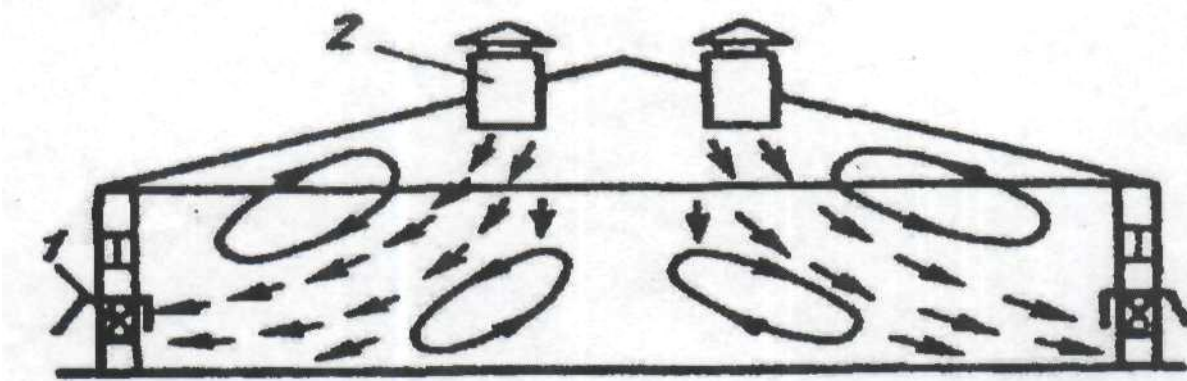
Вытяжная вентиляция с настенными вентиляторами: 1 - настенные вентиляторы; 2 - приточные шахты.
